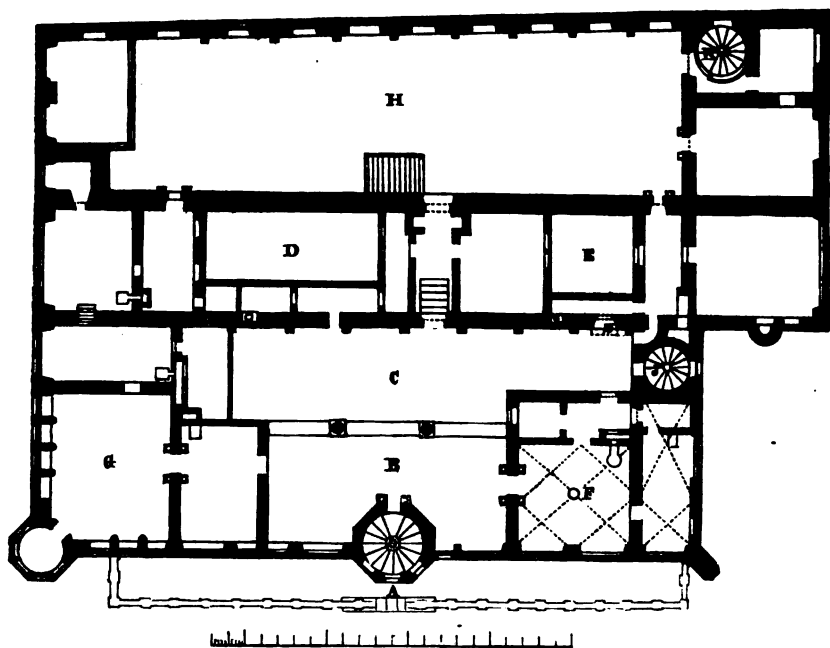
Rathhaus zu Rothenburg. Grundriss.
